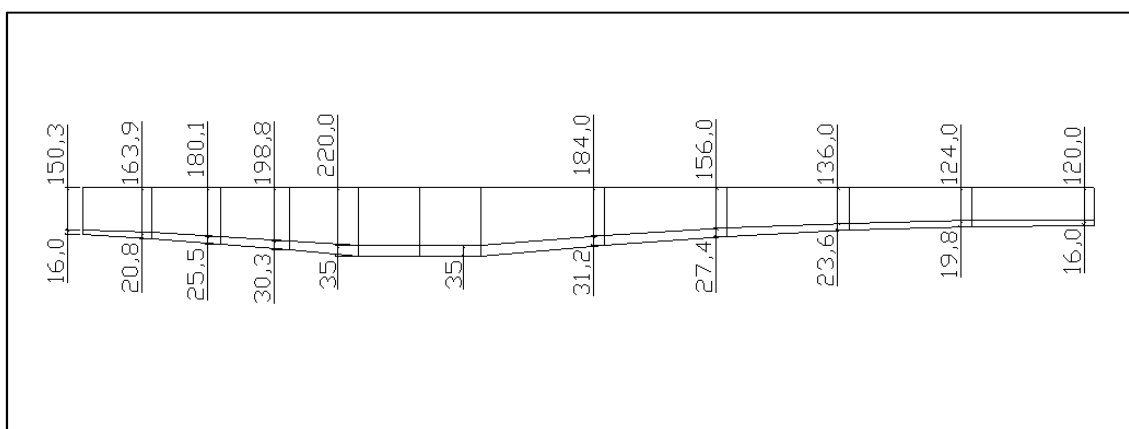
Corte longitudinal com a altura total da seção e espessura da laje inferior (unidades em cm).
